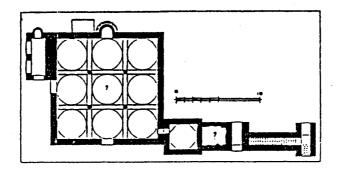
مسقط أفقي لجامع أحمد كتخدا العزب خلف باب العزب بقلعة القاهرة .
